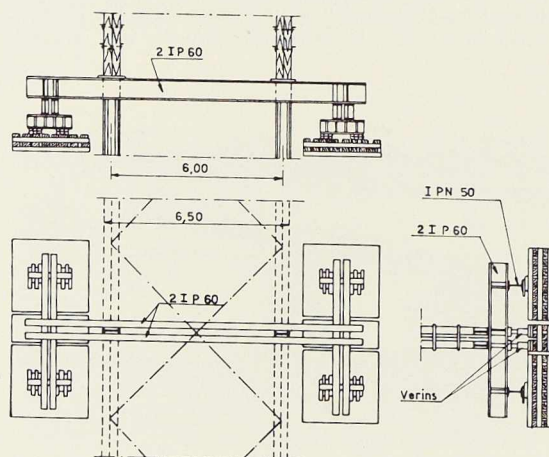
Dispositif de soulèvement des travées du pont sur la Save près de Belgrade.
